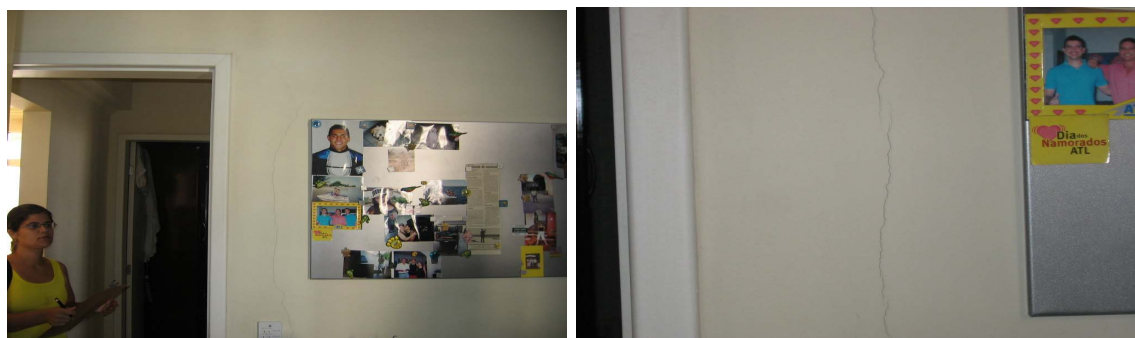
Fissura na parede do quarto próximo à boneca da porta e 10b - a fissura em detalhe.
